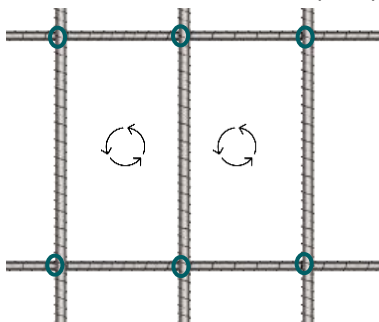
Geschweißte oder verdrahtete Bewehrungsstäbe
